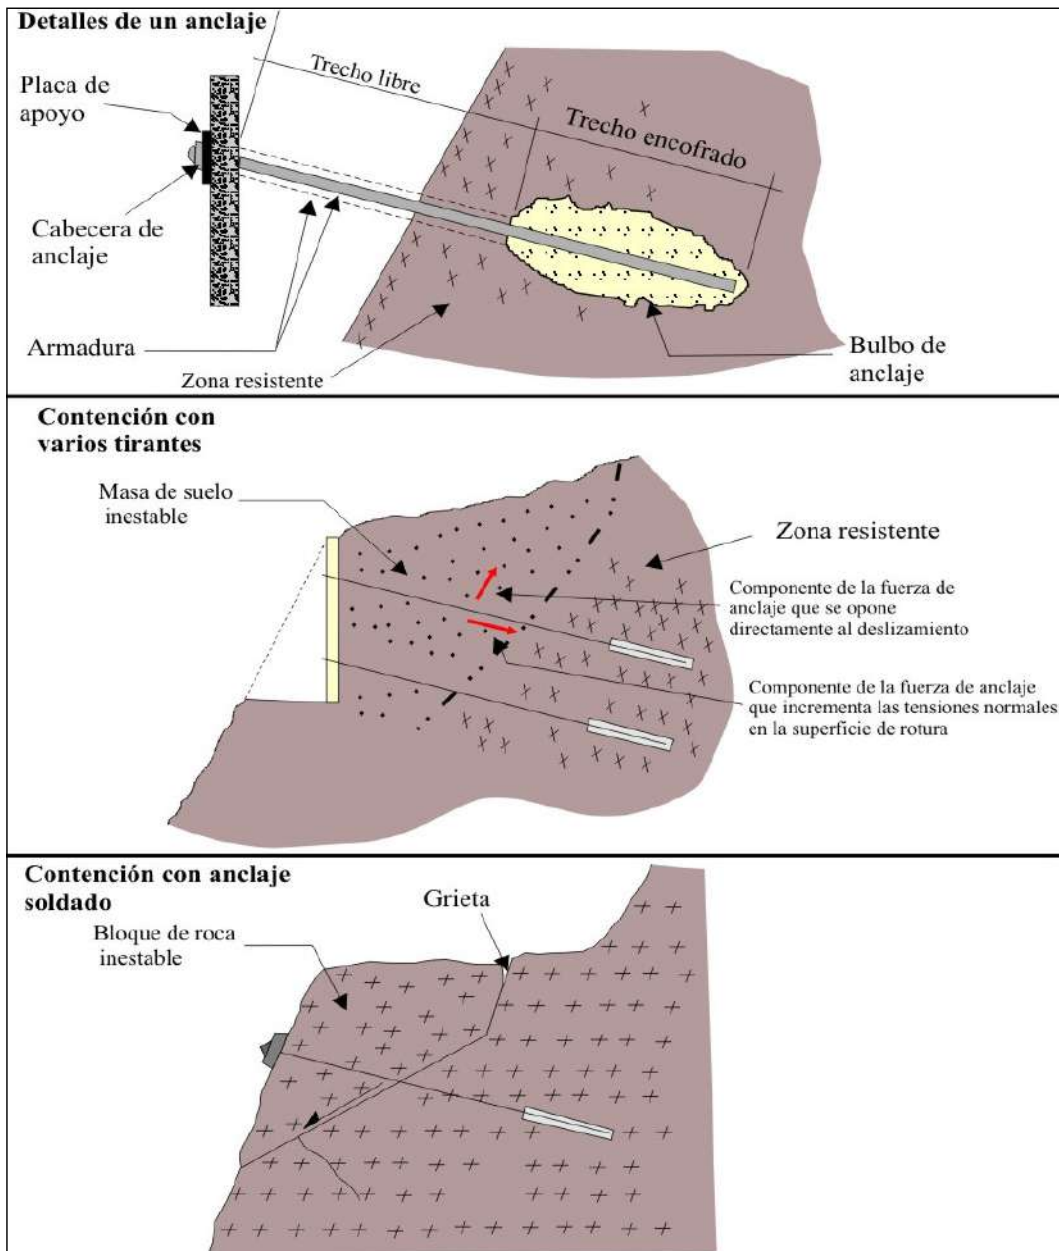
Detalles de un anclaje y ejemplos de aplicación (tomado de Ingemmet, 2000)
